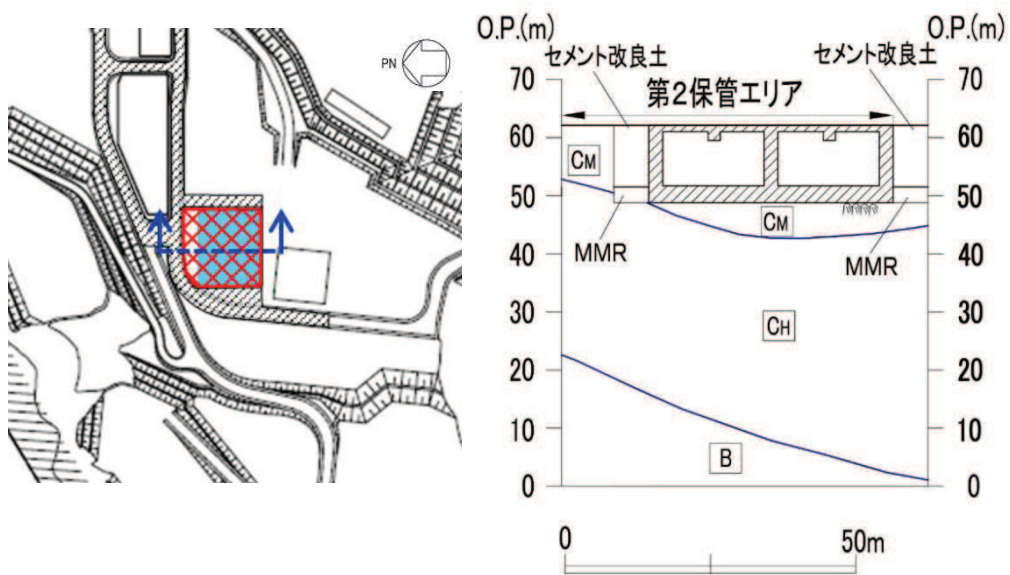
第2保管エリアの平面図及び地質断面図
